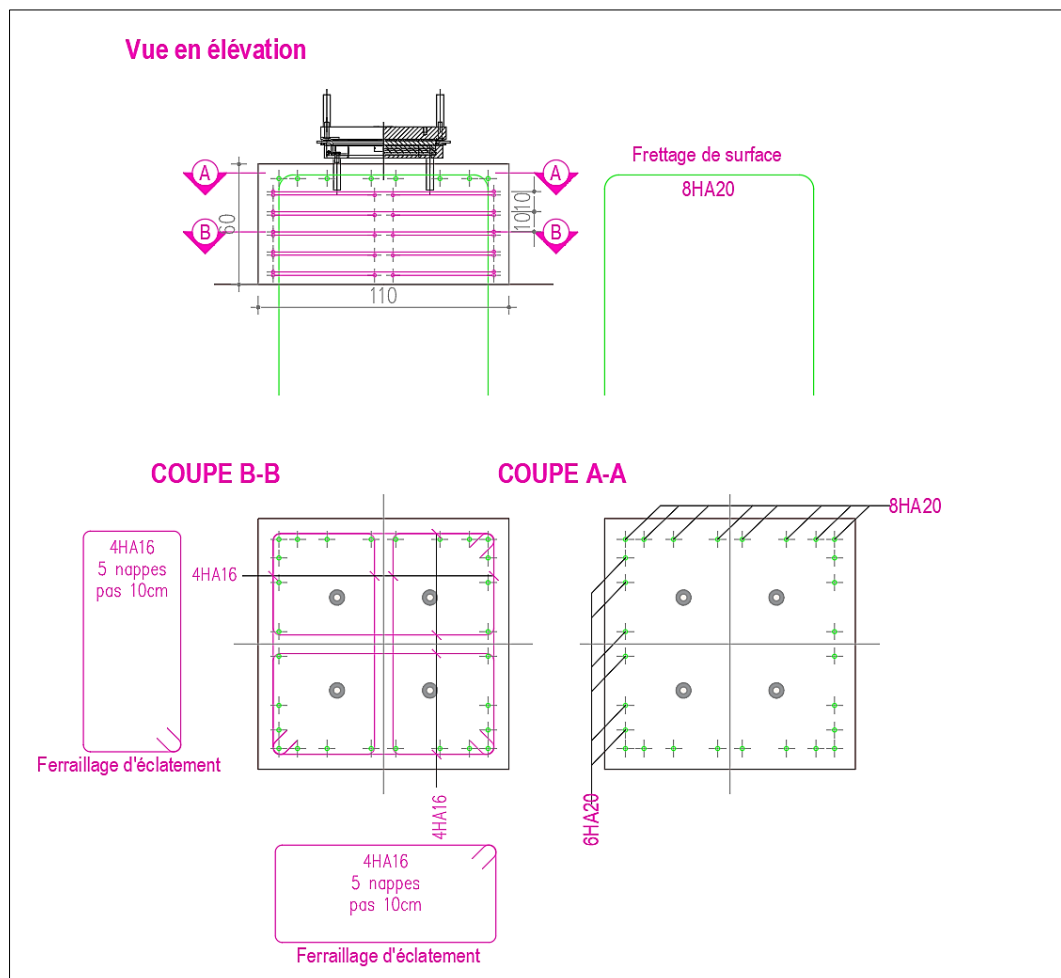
Plan de ferrailage des dés d'appui au niveau des culées
